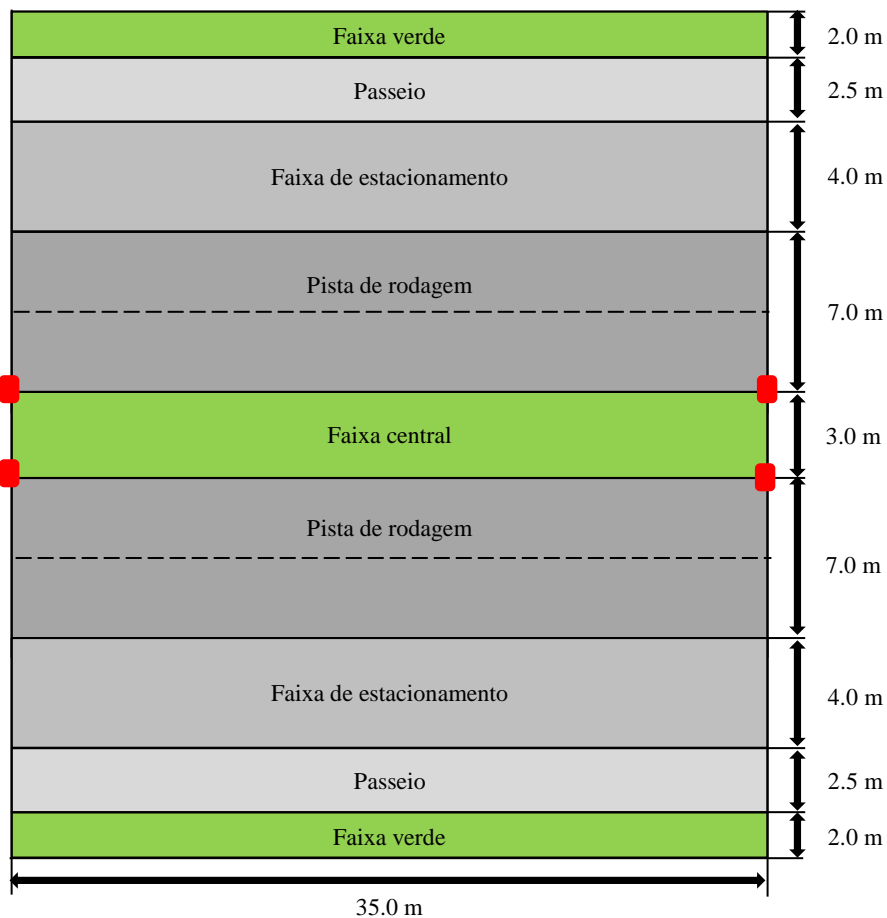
Troço da Avenida do Povo com os postes na faixa central.
